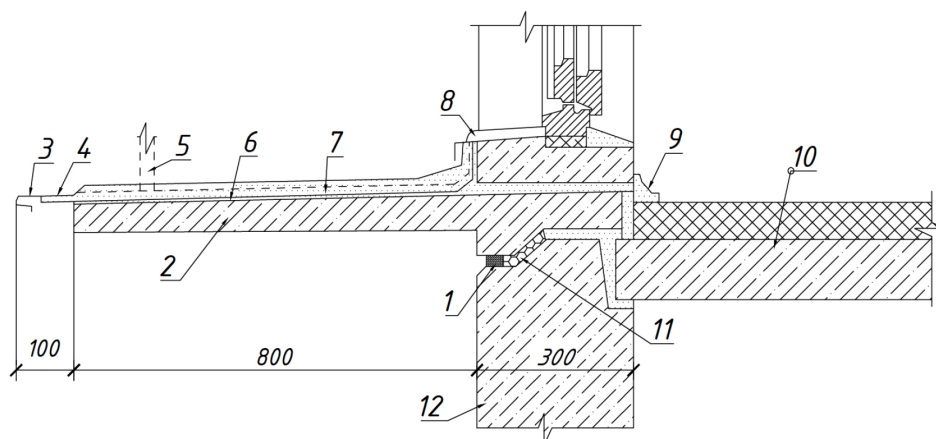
Узел заделки балконной плиты (по проекту):
